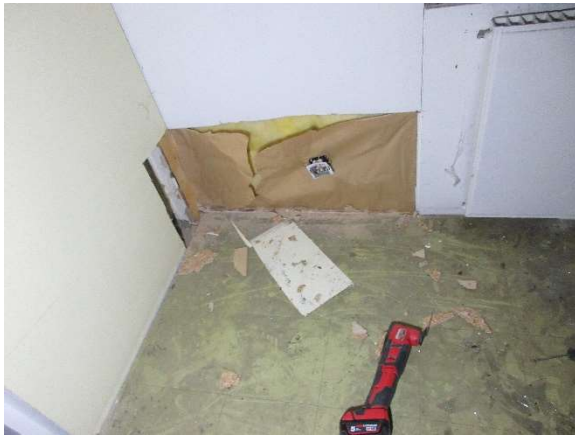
2.krs RA8 välipohjan eristeet poistettuna
